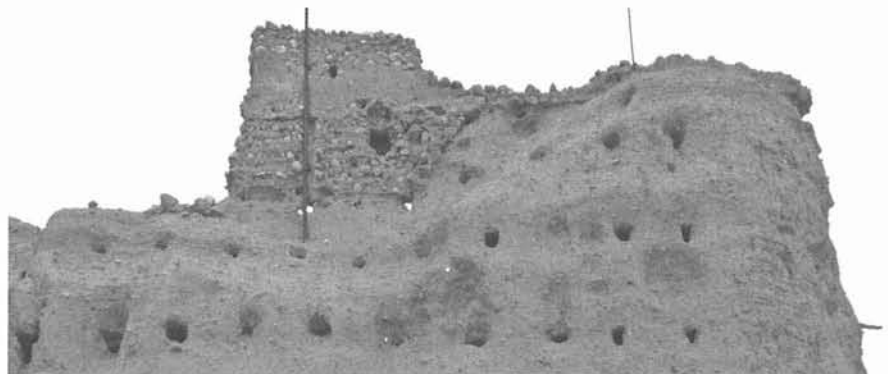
y 5. Restos de un muro septentrional de la fortaleza. Se puede apreciar la diferencia de sección y la falta de revestimiento en la parte baja del muro. Obsérvese la formación del mechinal con piedras que faciliten la extracción de los travesaños según avanza la construcción. La figura 5 reproduce los mechinales del muro occidental. Se pueden observar las piedras que forman el techo del hueco que dejó el travesaño que atravesaba el muro durante su construcción
